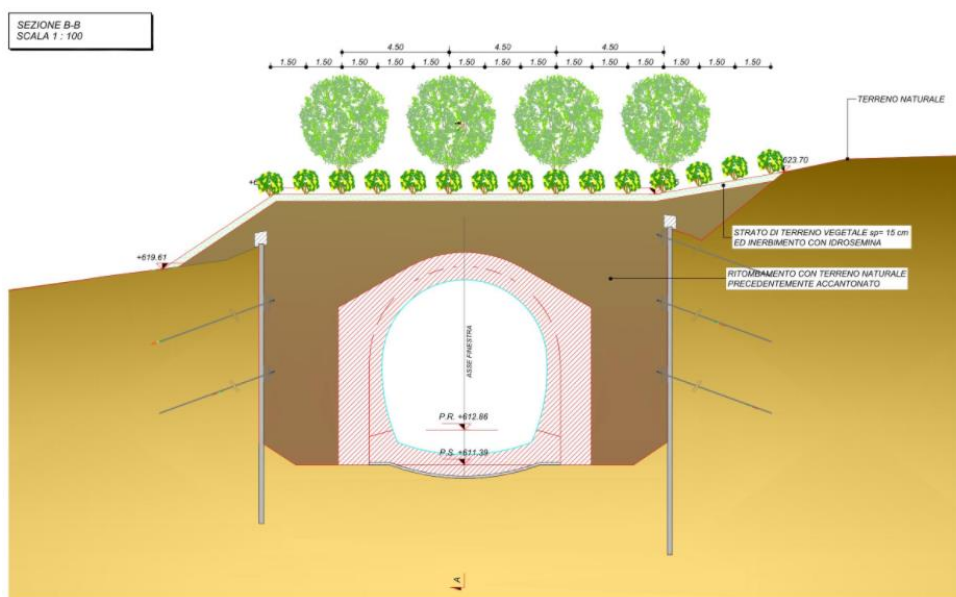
Opere a verde – Sezione di progetto imbocco della finestra di Chiasso.
